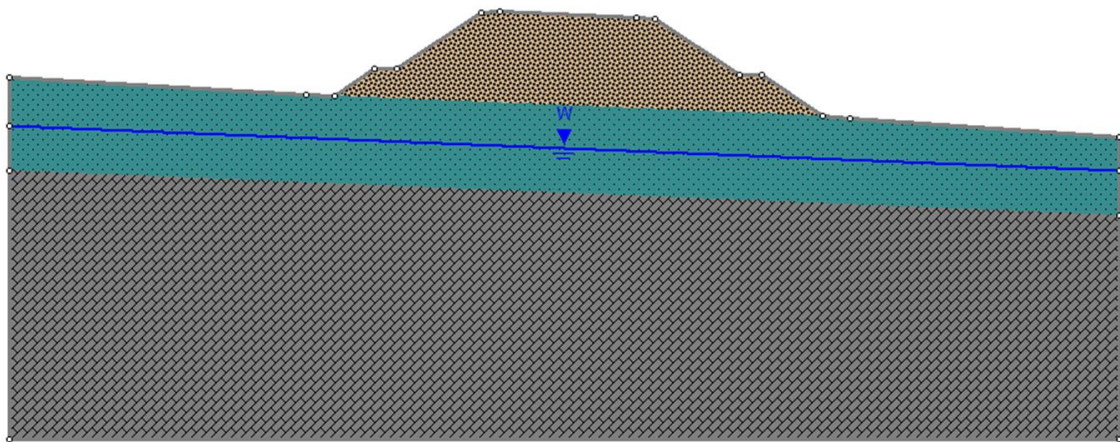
Sezione in rilevato (progressiva 0+775,00)
